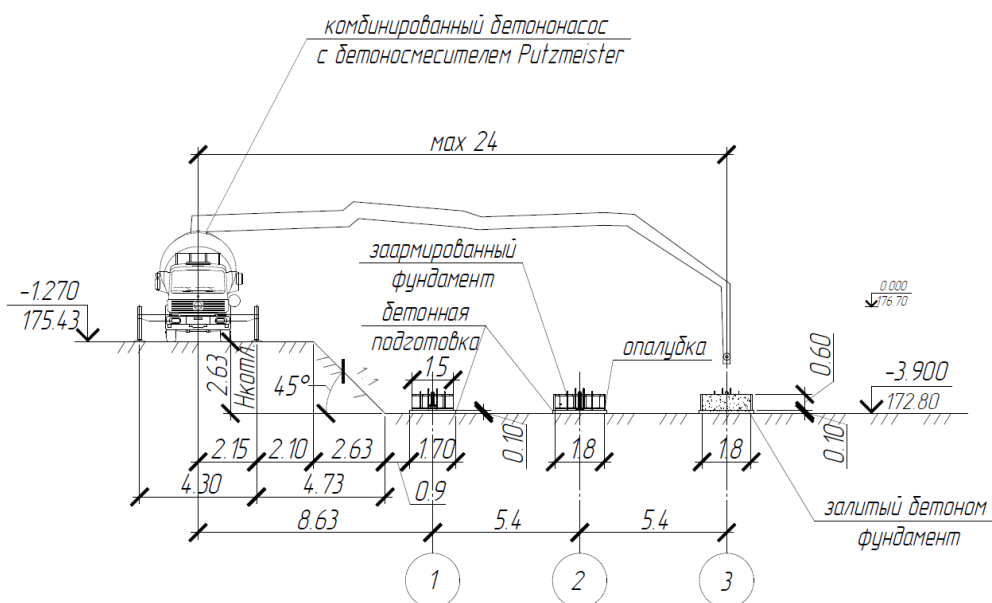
Схема организации работ при подаче бетонной смеси
